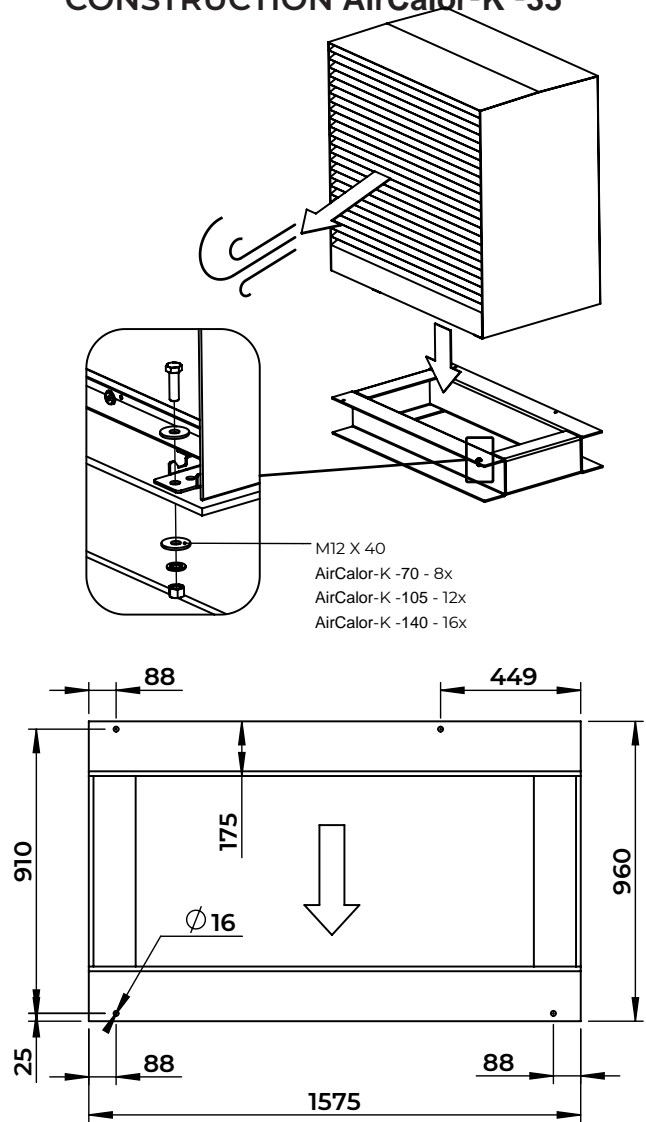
Dimensions et positions de montage pour une fondation en acier structural
